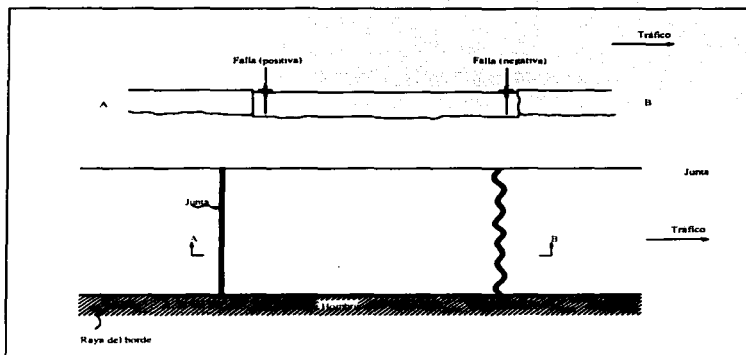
Fallas en juntas transversales y grietas.
